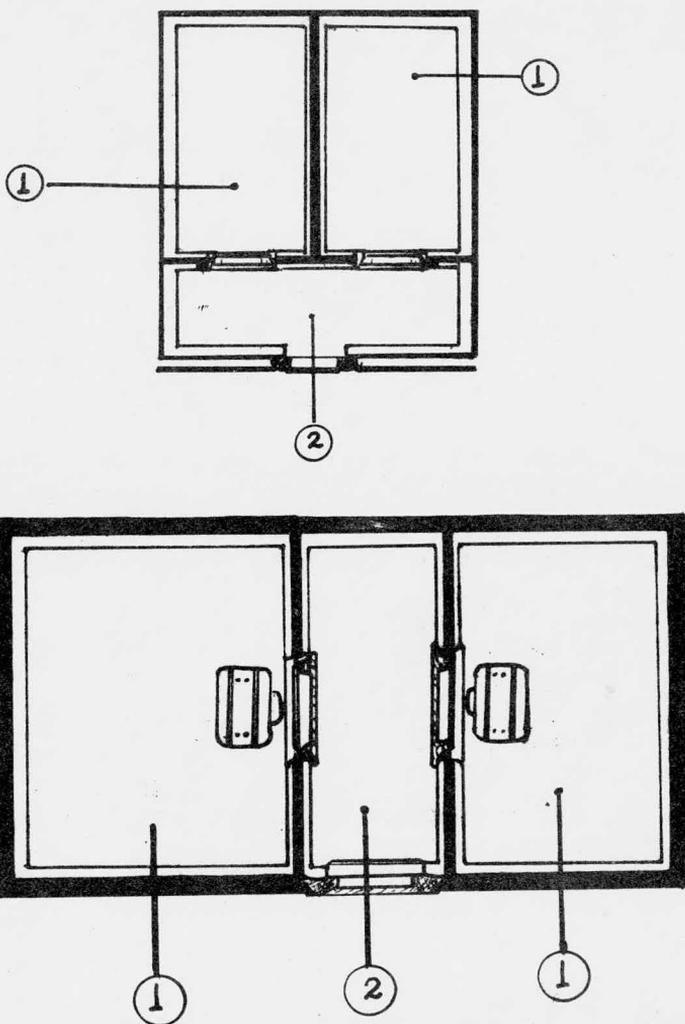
PLANTA DE UNA CAMARA CON ANTECAMARA
